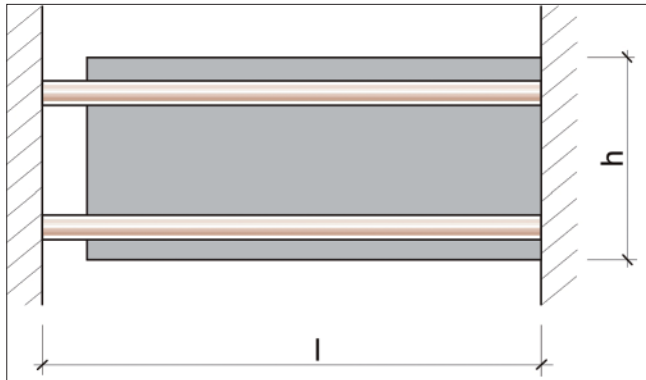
Modell ohne Verbund zwischen Beton und Bewehrung
